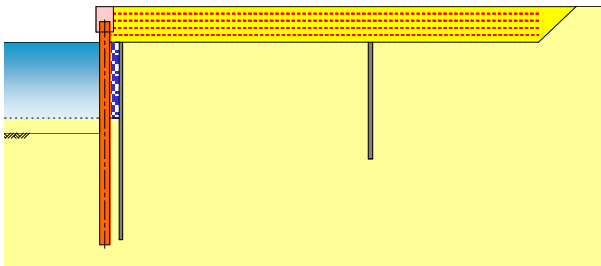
SG-Wall 式矢板岸壁の断面図(施工後)
